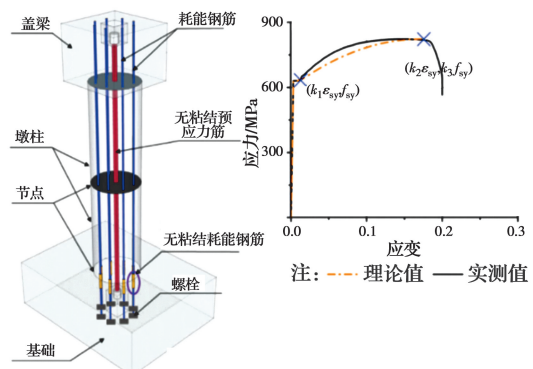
高强耗能钢筋桥墩^[11](单位:mm)
